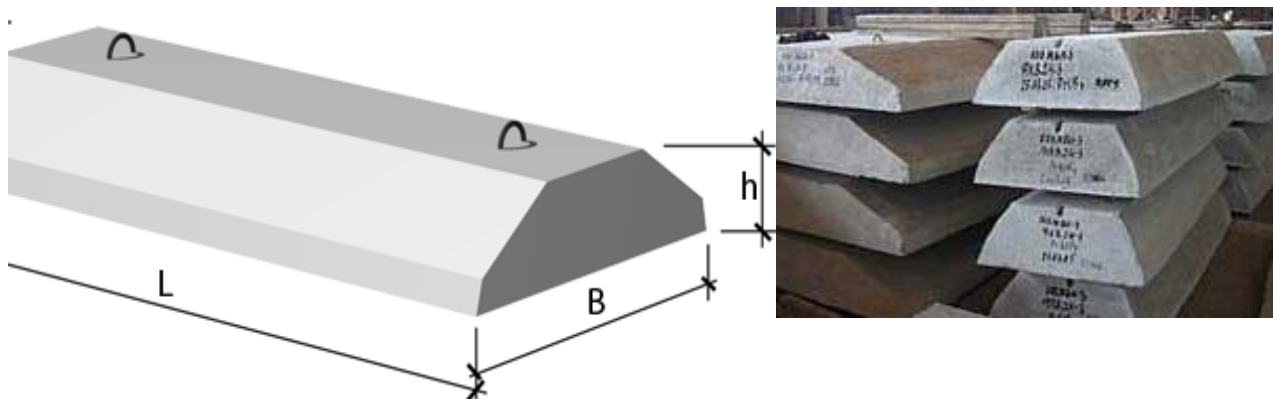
Фундаментные подушки (ФЛ)
